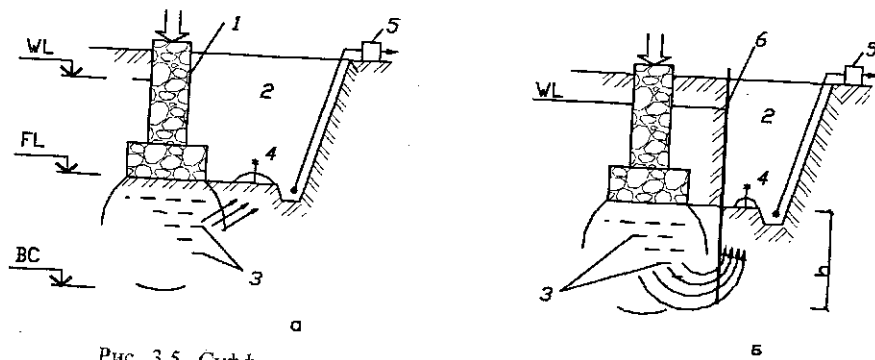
Суффозионное разрушение грунта под существующими фундаментами при открытом водоотливе: а — без ограждающего шпунта; б — при шпунте, не забитом до водоупора или недостаточно заглубленном ниже дна котлована; 1 — существующий фундамент; 2 — котлован возводимого здания; 3 — области возможного образования пустот; 4 — грифоны; 5 — насос; б — шпунт; *h* — глубина погружения шпунта ниже отметки дна котлована
